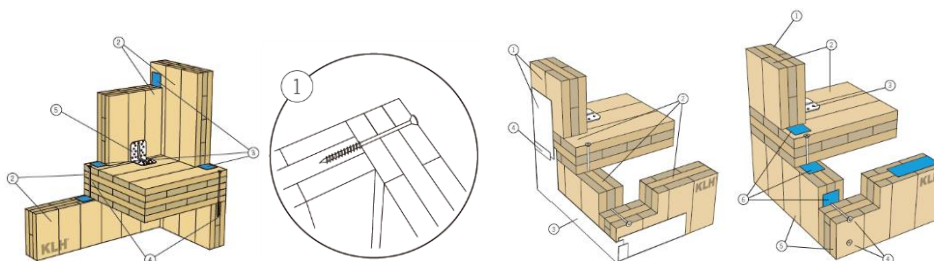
Ligação entre paredes exteriores e pavimento intermédio (KLH Massivholz GmbH, 2013b).
